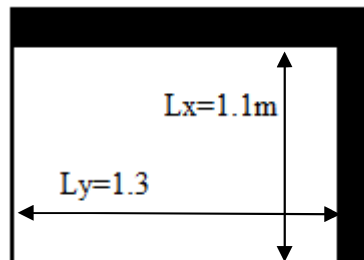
Schéma d'une dalle pleine sur deux appuis
